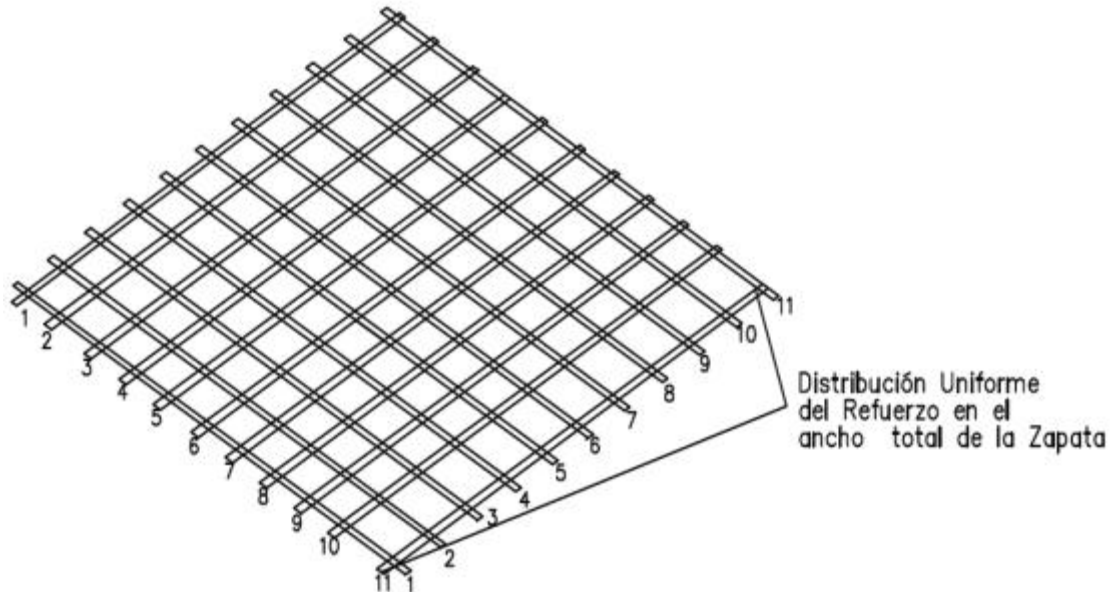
Armado de zapata cuadrada en dos direcciones
